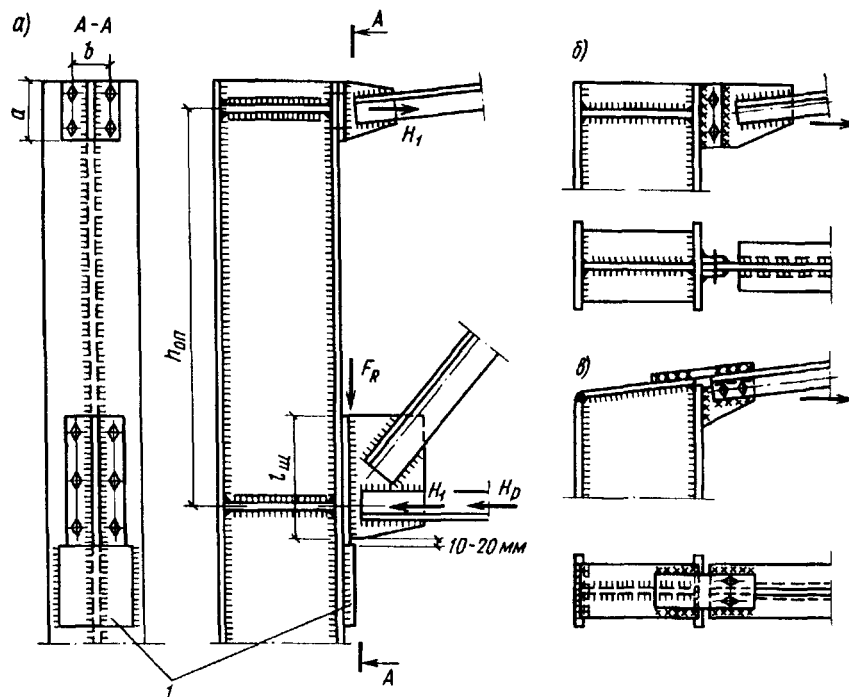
Узел опирания стропильной фермы на колонну сбоку
